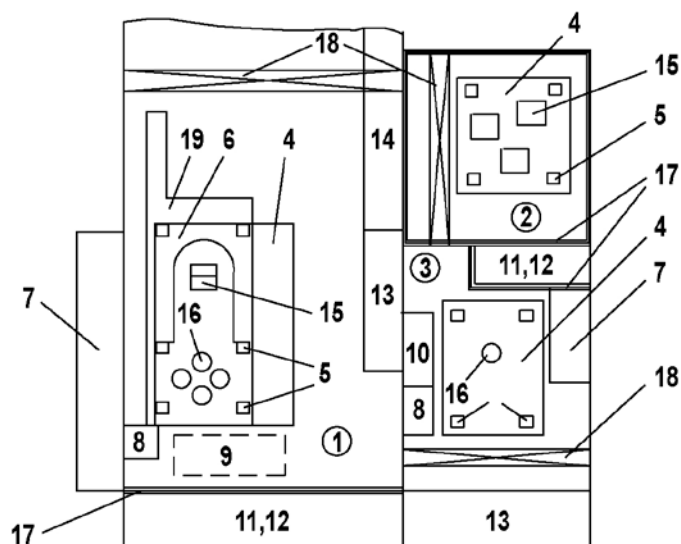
Планировка типовой ЛВИ для обработки вибропрочности КА:
